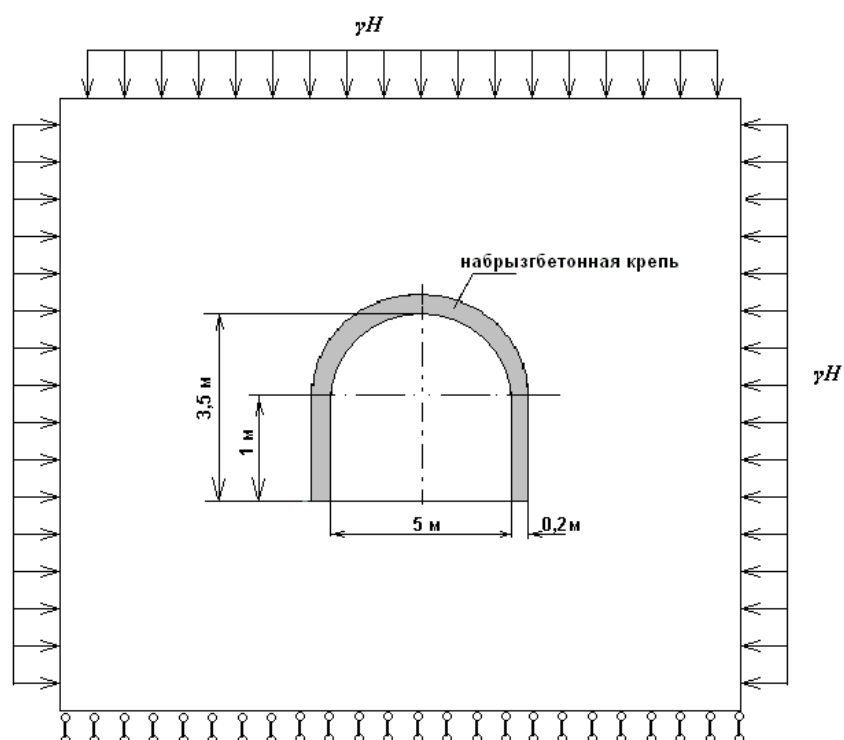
Расчетная схема выработки с набрызгбетонной крепью, толщиной 20 см.
